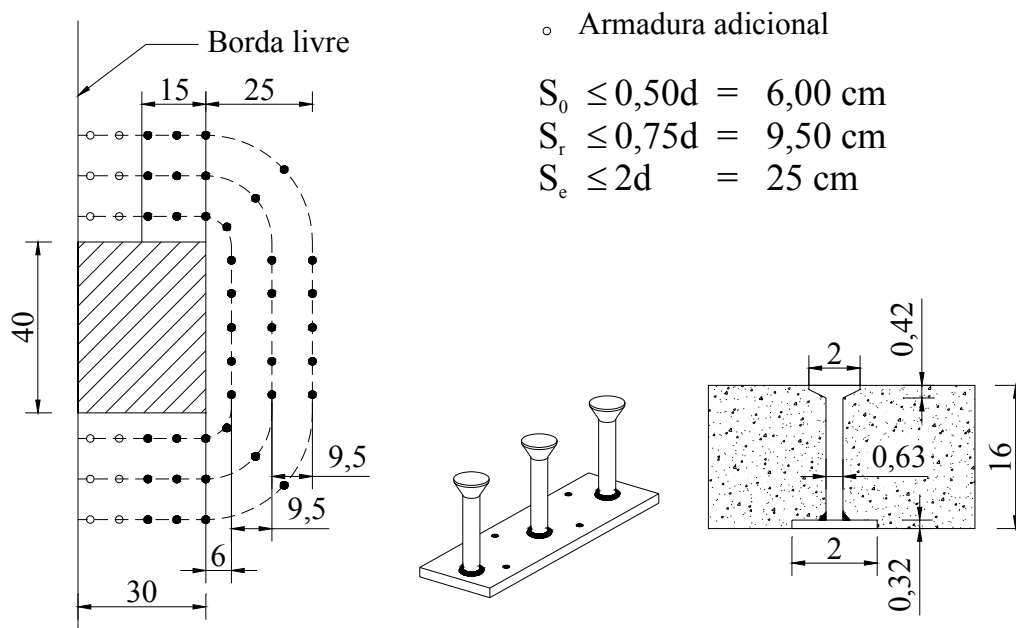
10 Arranjo da armadura de punção para o pilar P4
